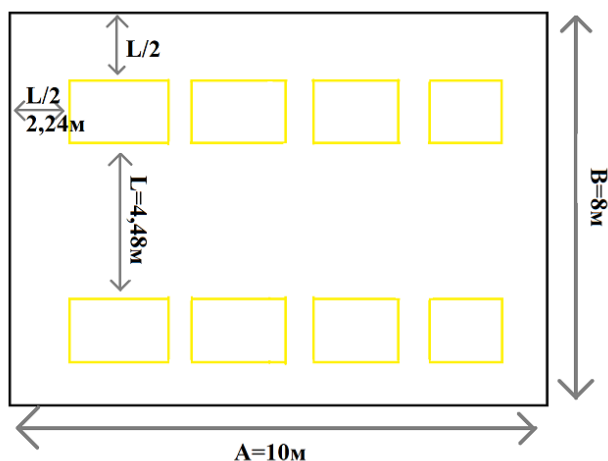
План помещения и размещения светильников с люминесцентными лампами
